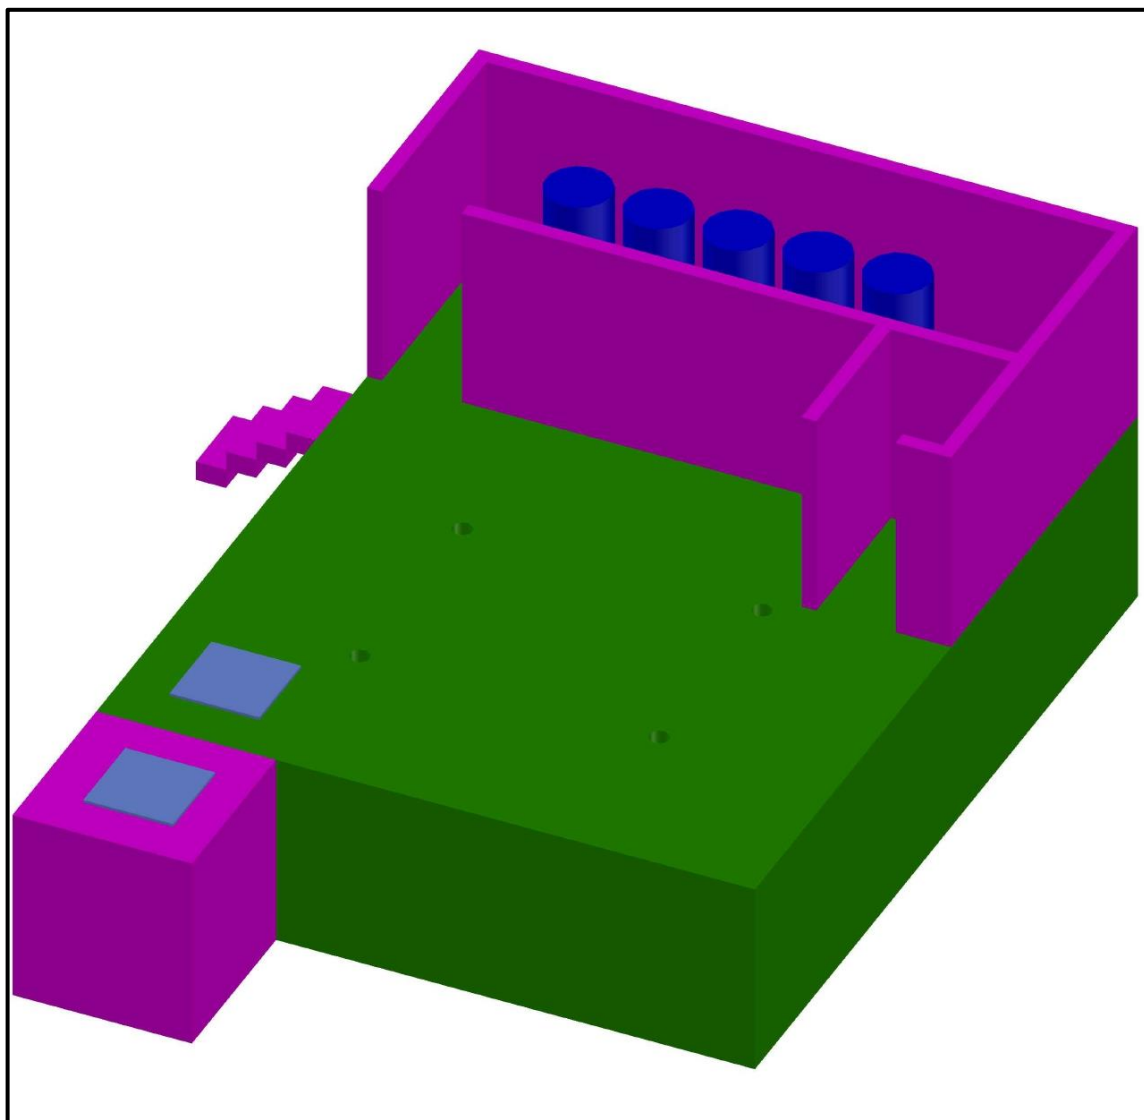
Modelación 3D tanque de almacenamiento y planta existentes
